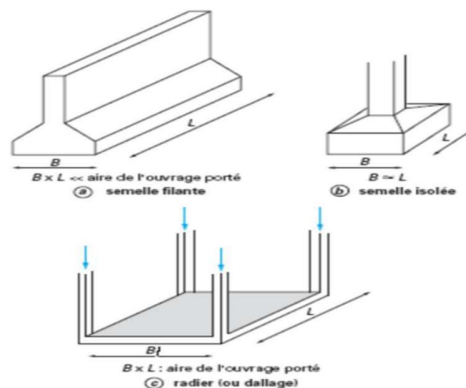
Fondation superficielle (Semelle filante(a), Semelle isolée(b), Radier général(c))
